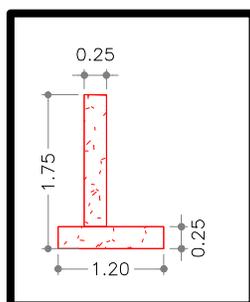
Dimensiones de dentellón bajo la losa de cimentación de ambas estructuras de cruce
